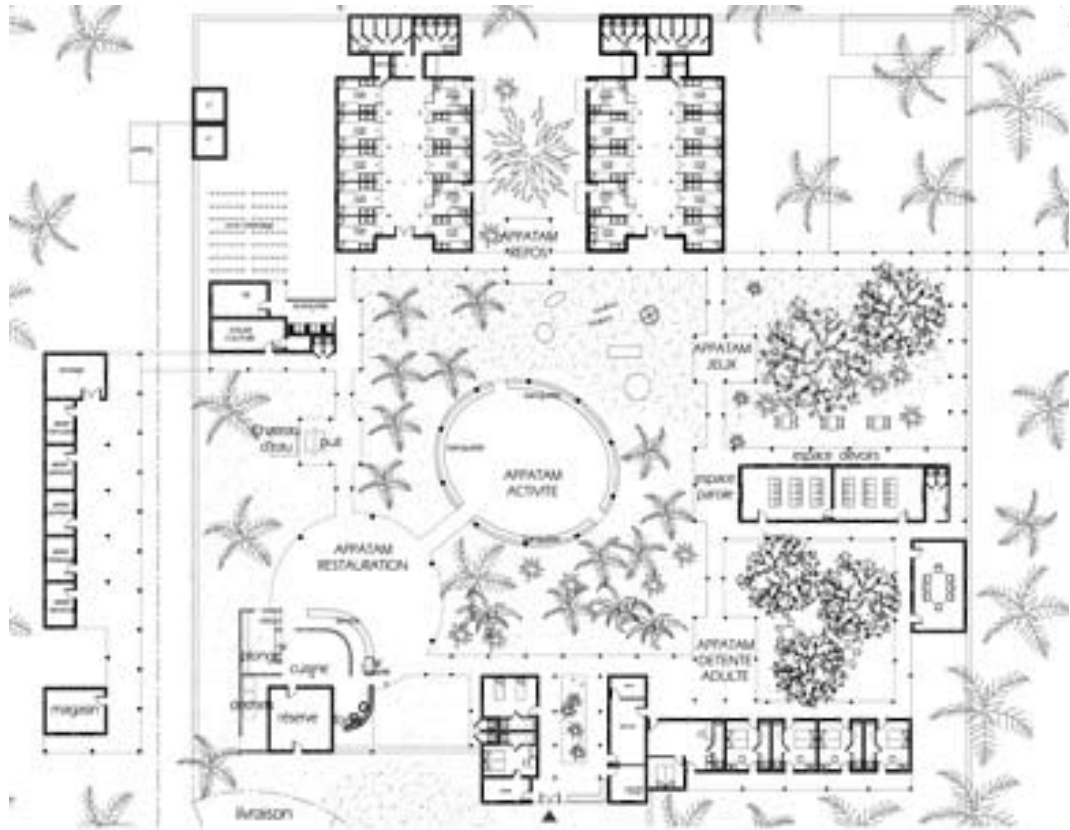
Planta do centro para Crianças em perigo, em Avrankou, Benin.
